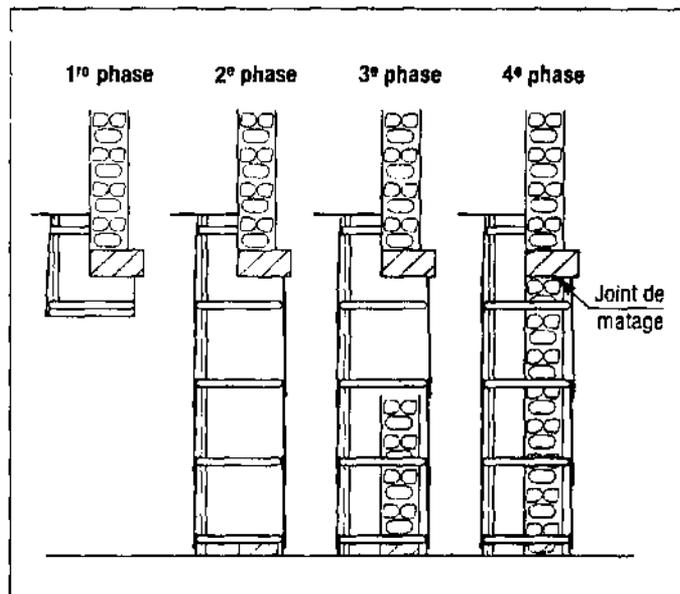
Reprise en sous-œuvre d'un mur en maçonnerie.
